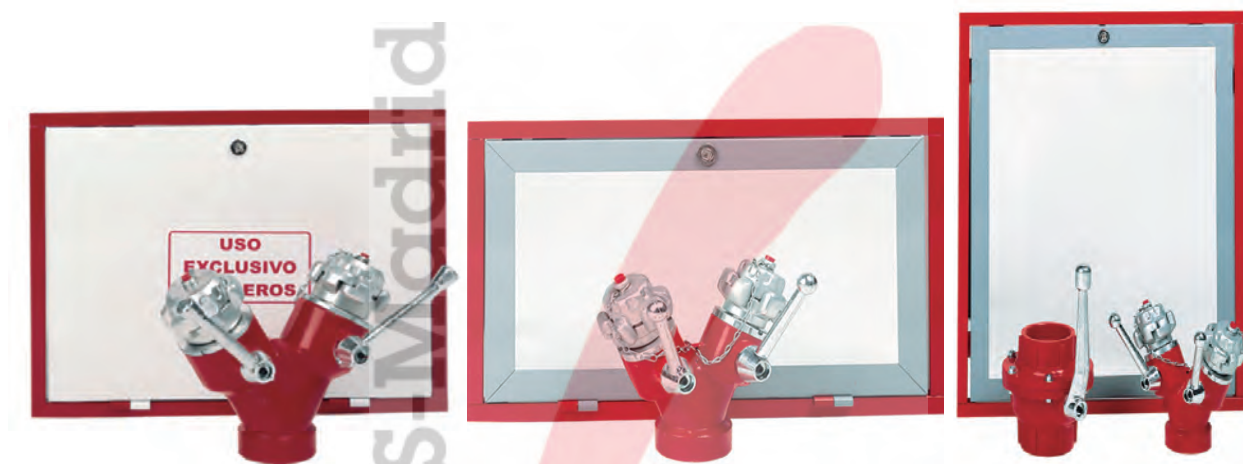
Toma de fachada, salida en piso y salida en piso con llave de seccionamiento del sistema de columna seca
